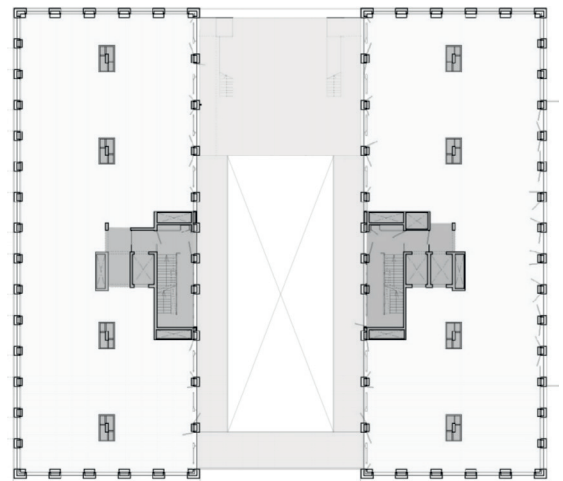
Solid Oud West by Tony Fretton Architects
